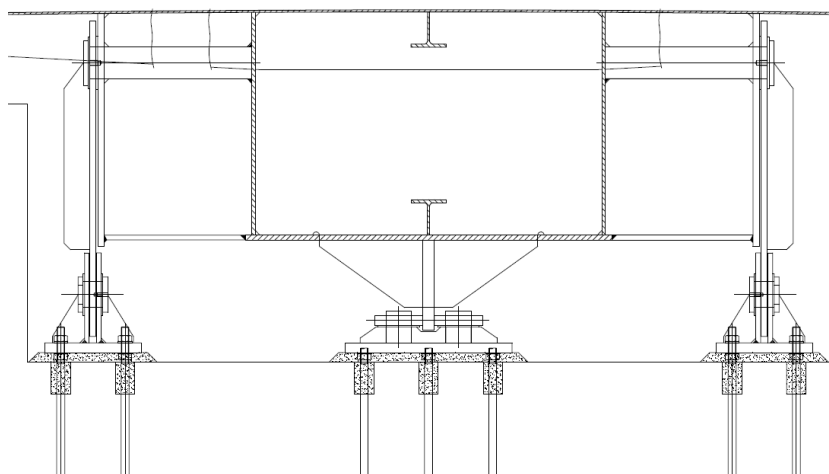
Secção transversal do tabuleiro concebido com viga caixão, na zona dos encontros [24].
